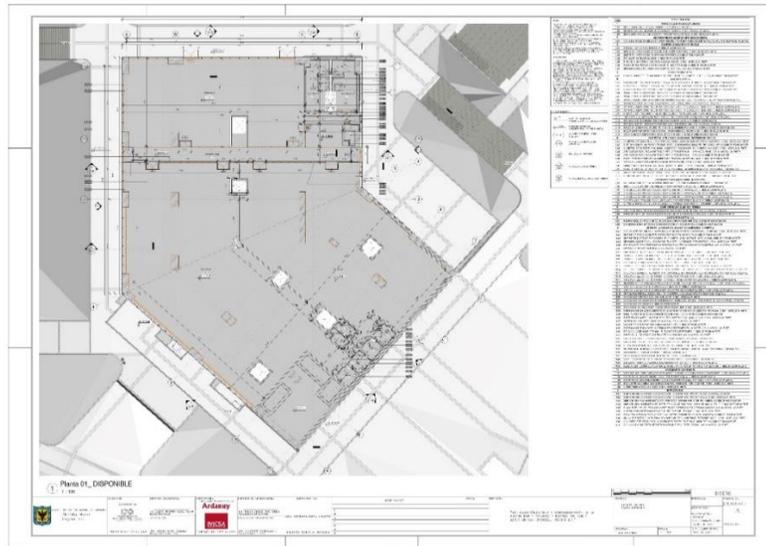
Planta Mezzanine estación intermedia - Victoria.
